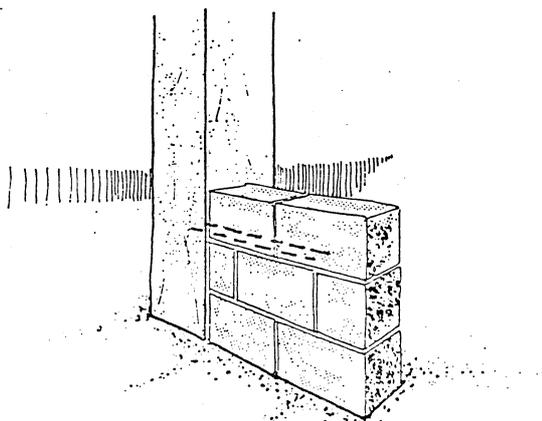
Ligação da alvenaria com o pilar através de barras de aço “cabelos”
